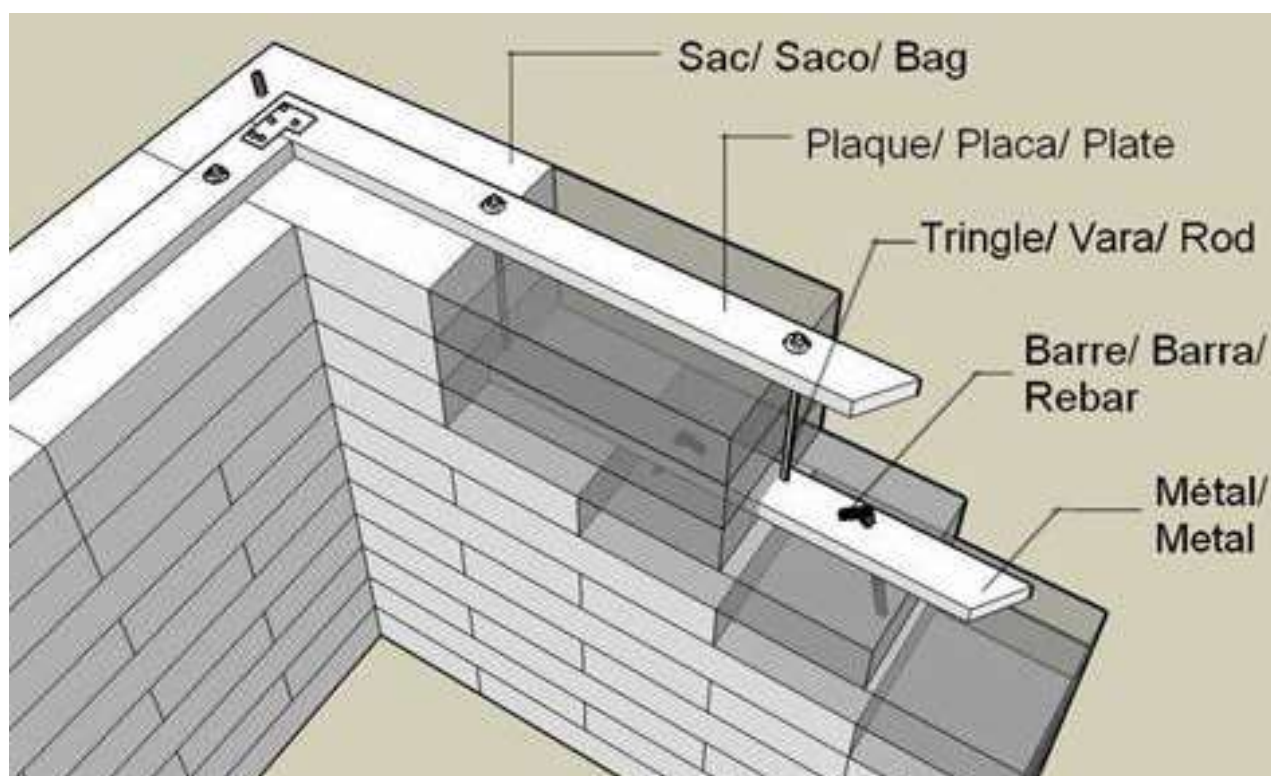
Esquema de disposición de la viga de amarre de madera sobre el muro de mampostería.
